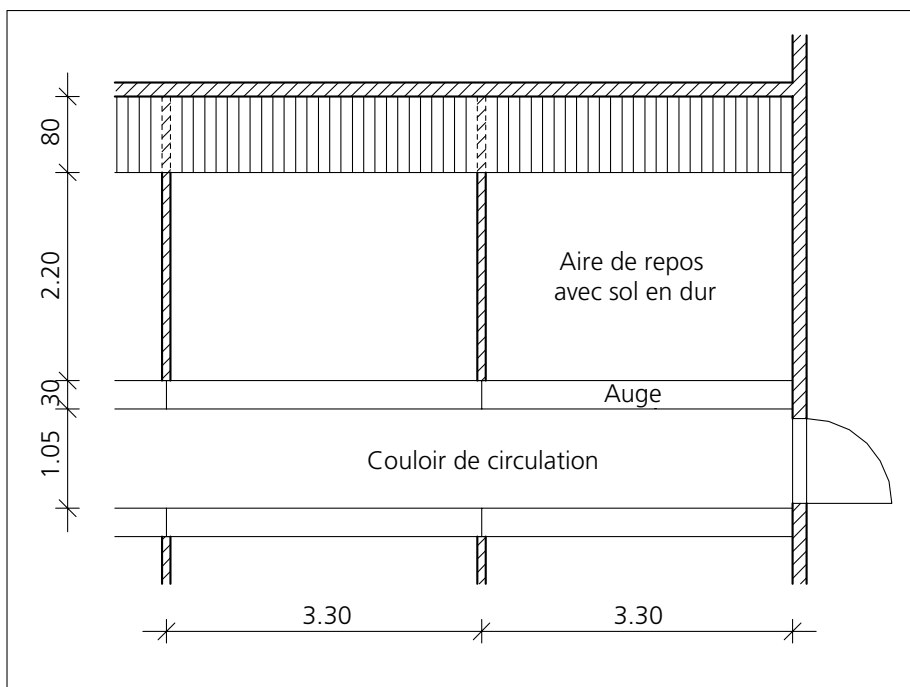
Plan du système de «caillebotis partiel», avec auge en longueur et boxes pour dix animaux.
